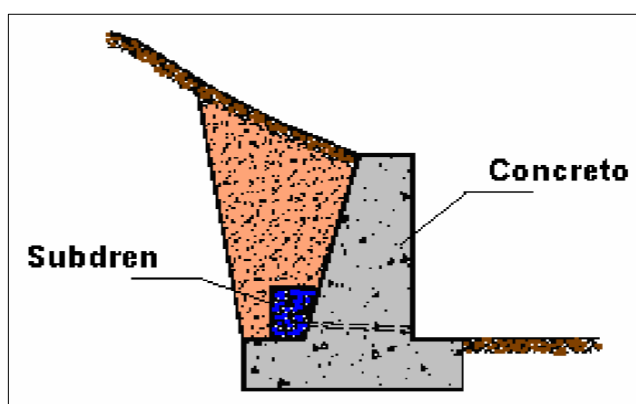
Esquema de un muro de concreto para la estabilización de taludes.
